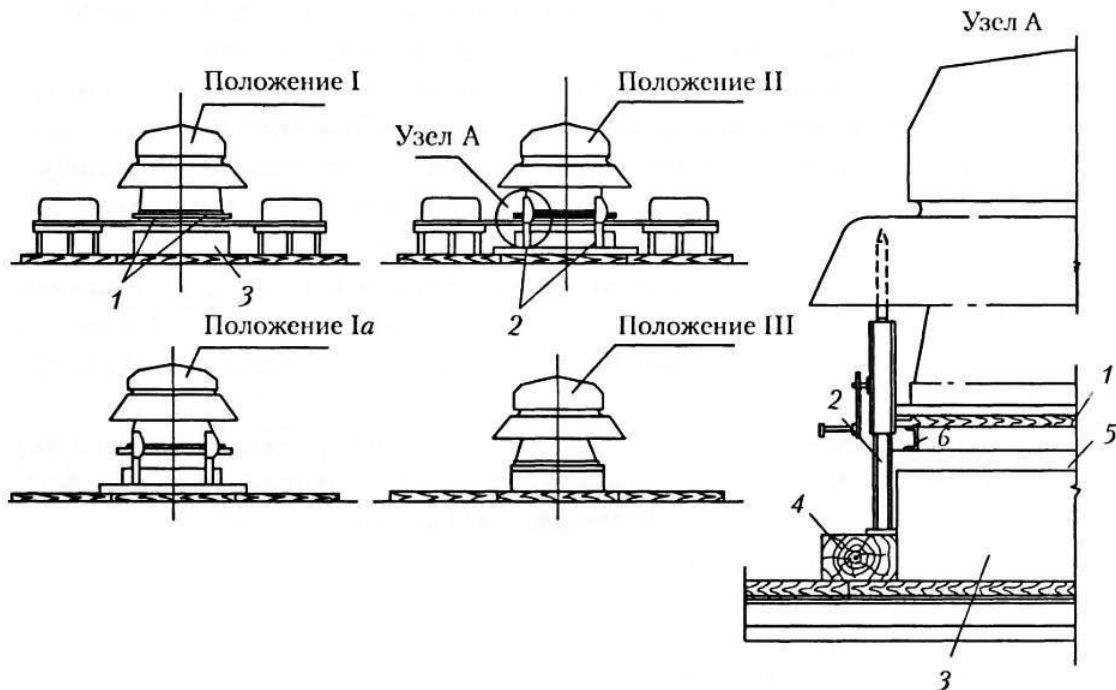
Схема монтажа крышных вентиляторов с помощью домкратов:
